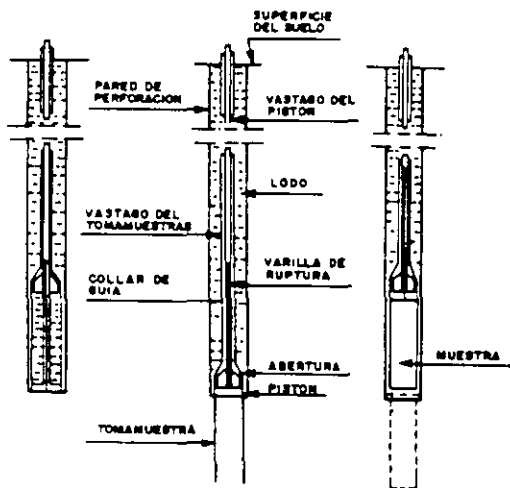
Esquema del tomamuestras de pistón Olsen.
